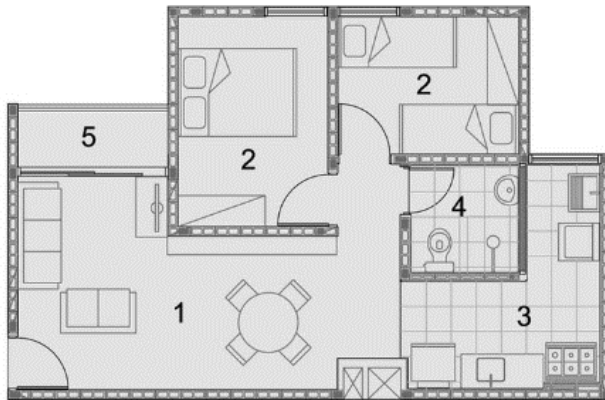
y 102. Plantas arquitectónicas de los departamentos de la unidad habitacional Heliópolis
